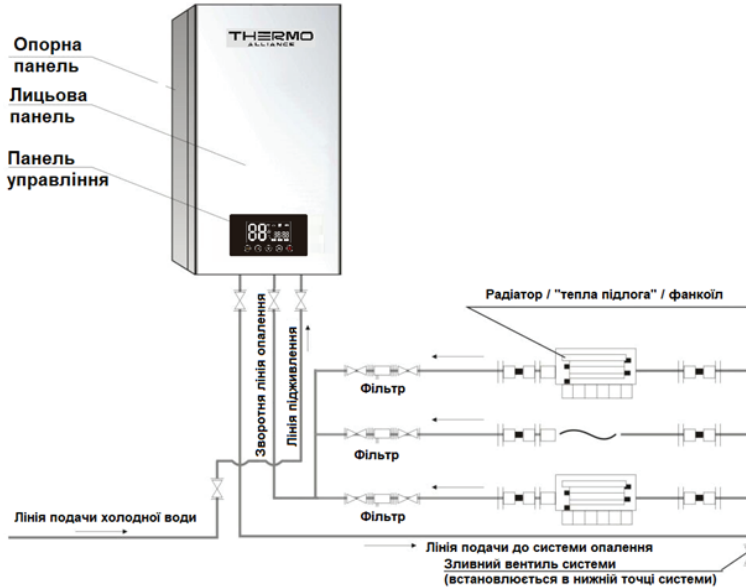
Зовнішній вигляд і принципова схема під'єднання
